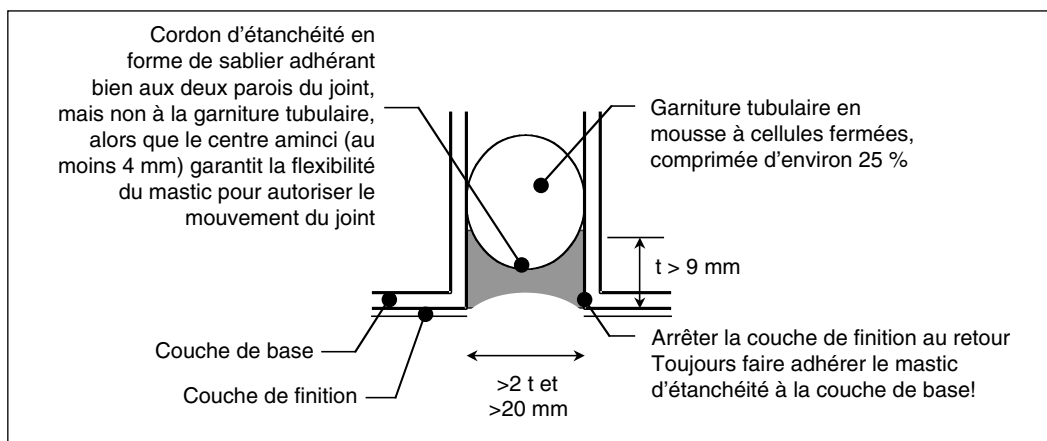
Façon tout indiquée de réaliser un joint d'étanchéité
